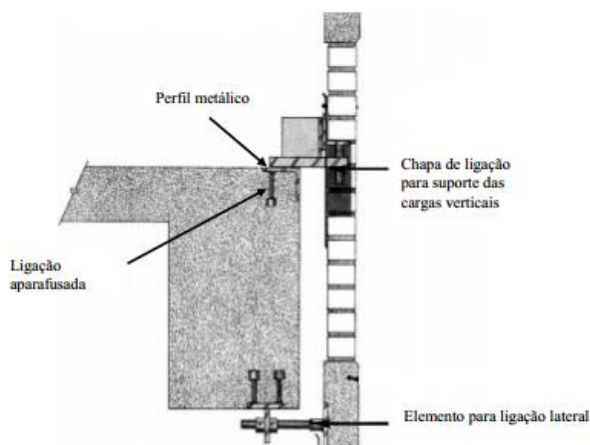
Ligação entre o painel prefabricado e a estrutura. [20]
